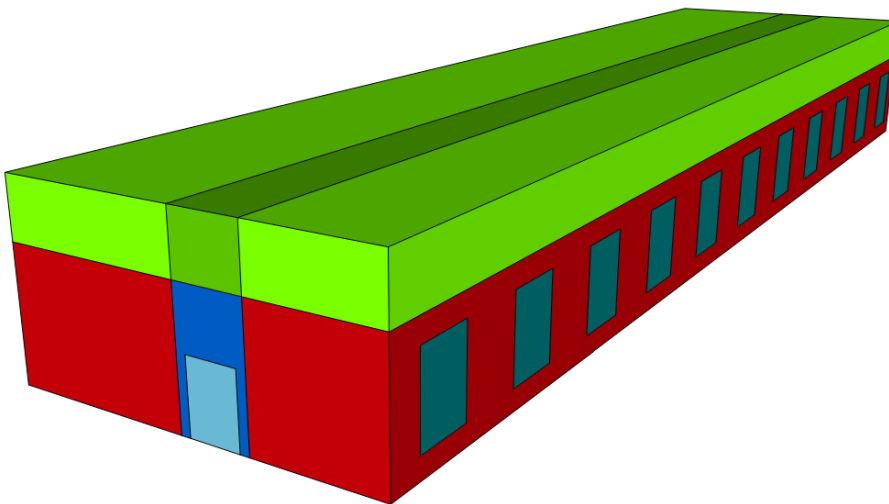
Modelo de la planta baja del CUD, visto desde el S
